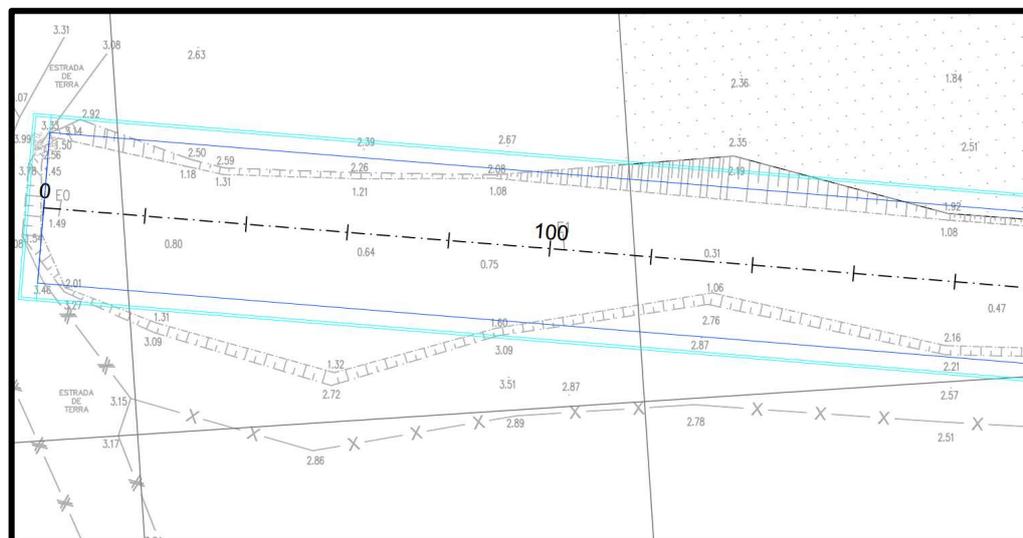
Exemplo de planta baixa de corpo d’água. Fonte: SEDURB
